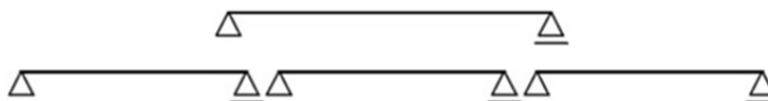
Modèles mécaniques des poutres d'un pont à poutres
